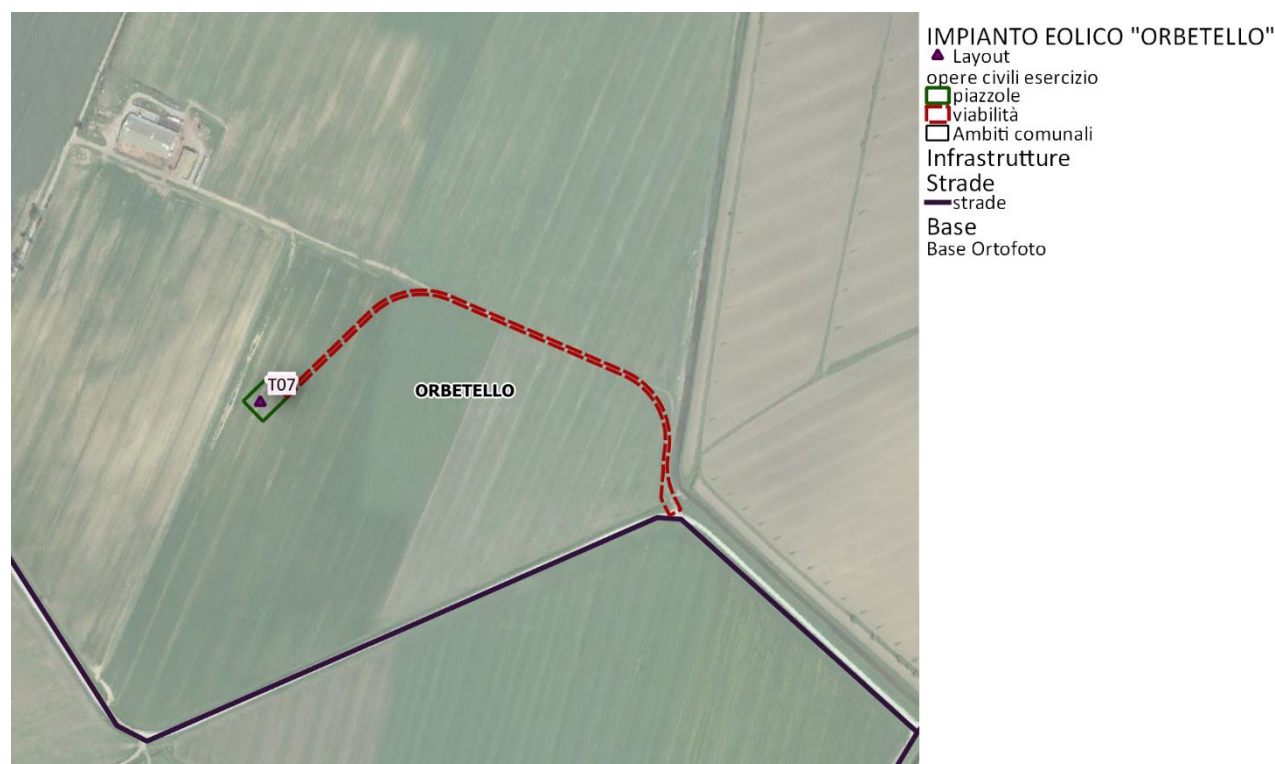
Stralcio planimetrico sulla progettazione della nuova viabilità.
